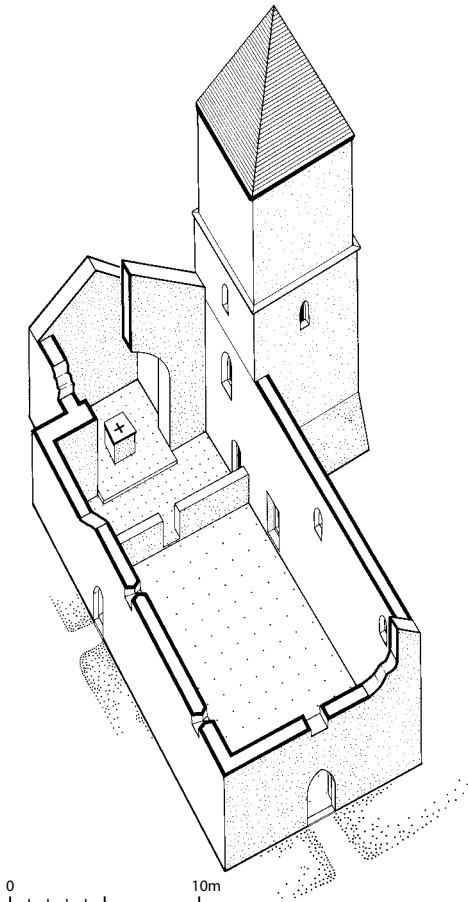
, oben: Worb, Kirche mit ersetzter Westmauer und um 1431 bis 1435 erbautem Turm. Grundriss. M. 1:400.
